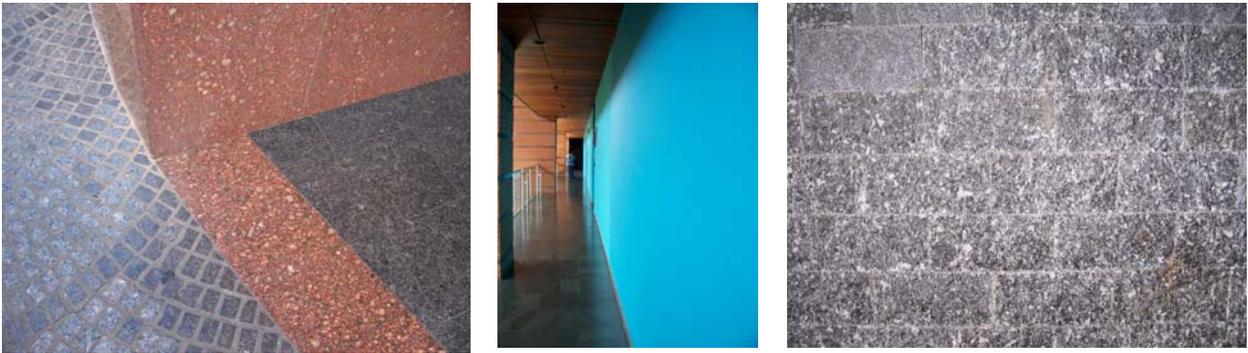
Fotos pavimentos de mármol, paramentos con enlucido y pintura –plafón de techo en madera, pasamanos de vidrio y, piedra azul cortada en paramento.
